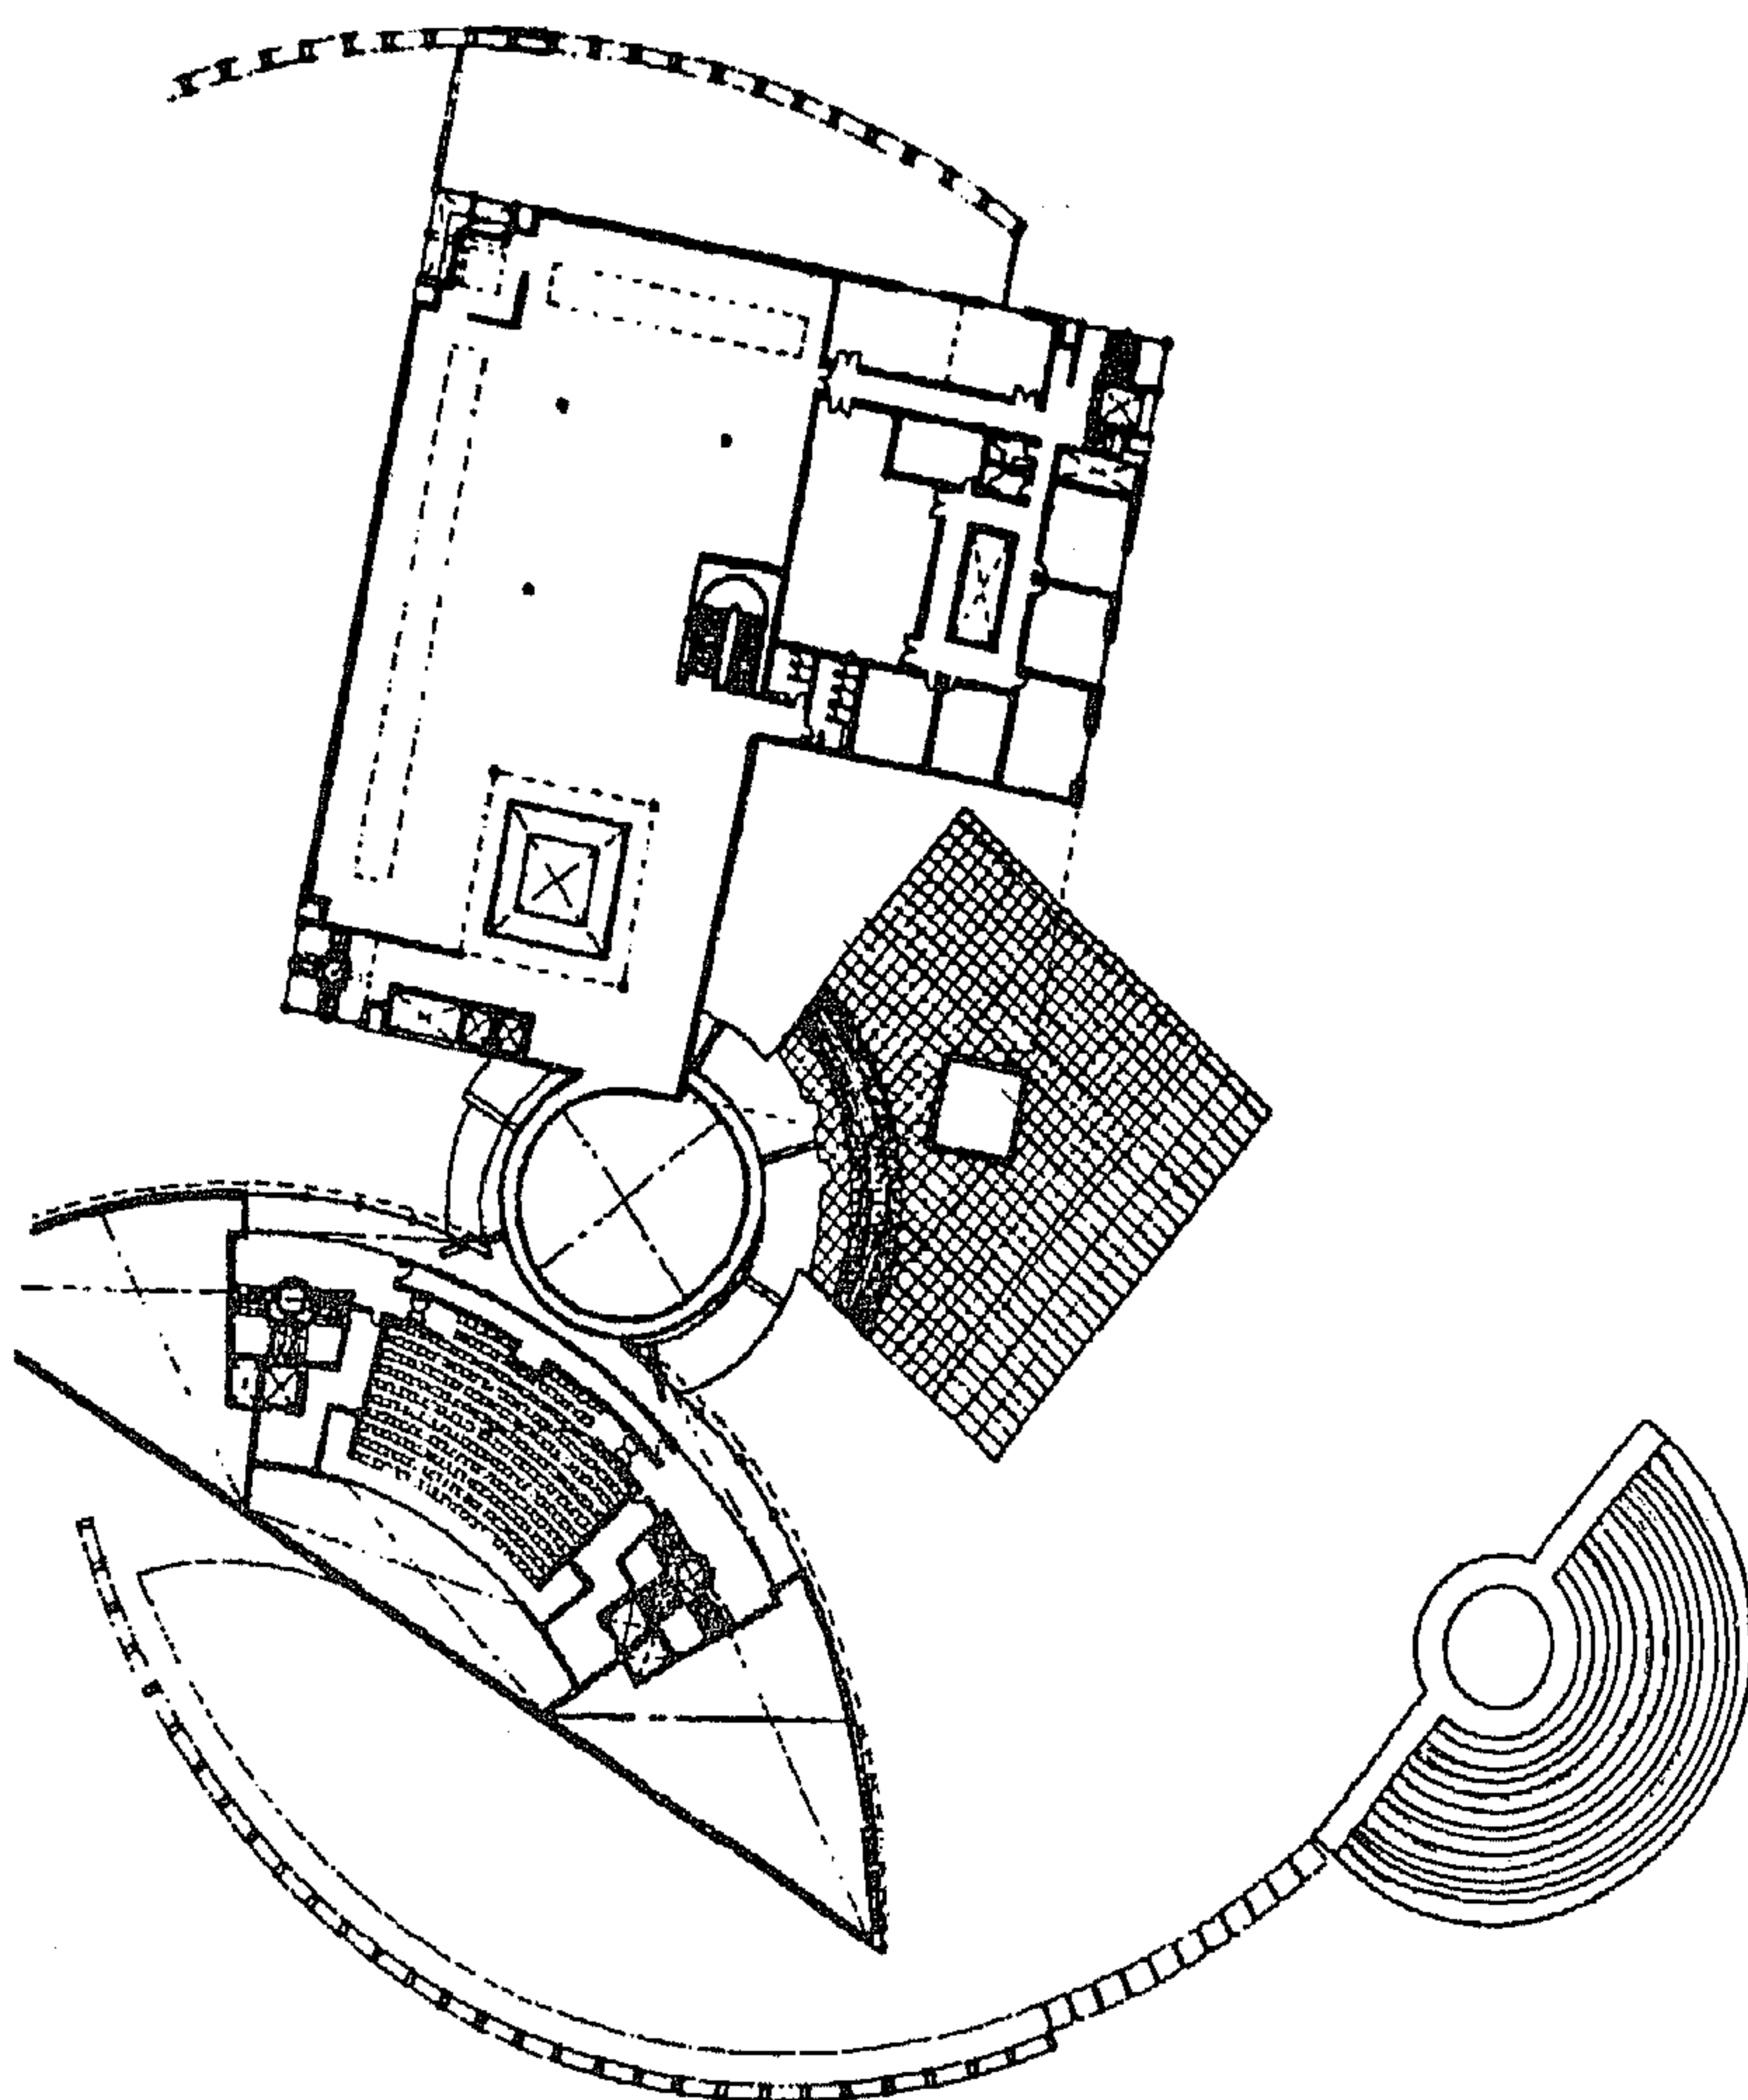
مسقط أفقي الدور الأول
